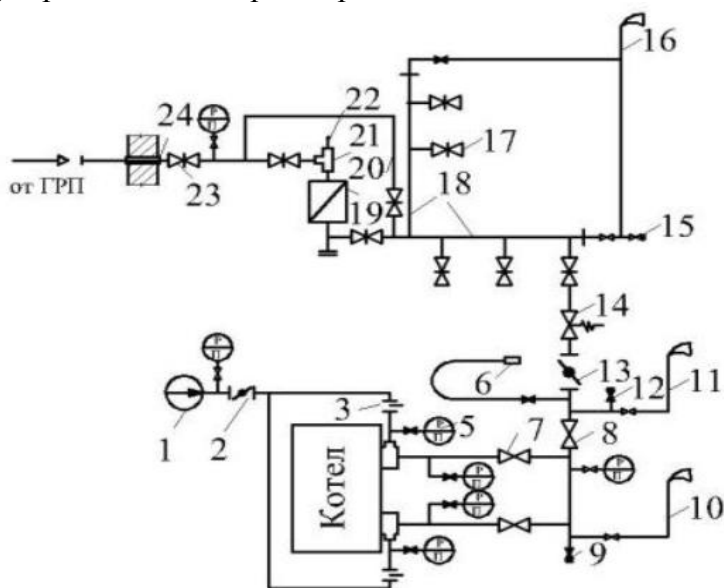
Схема газопроводов котельной и обвязочных газопроводов котельной установки:
